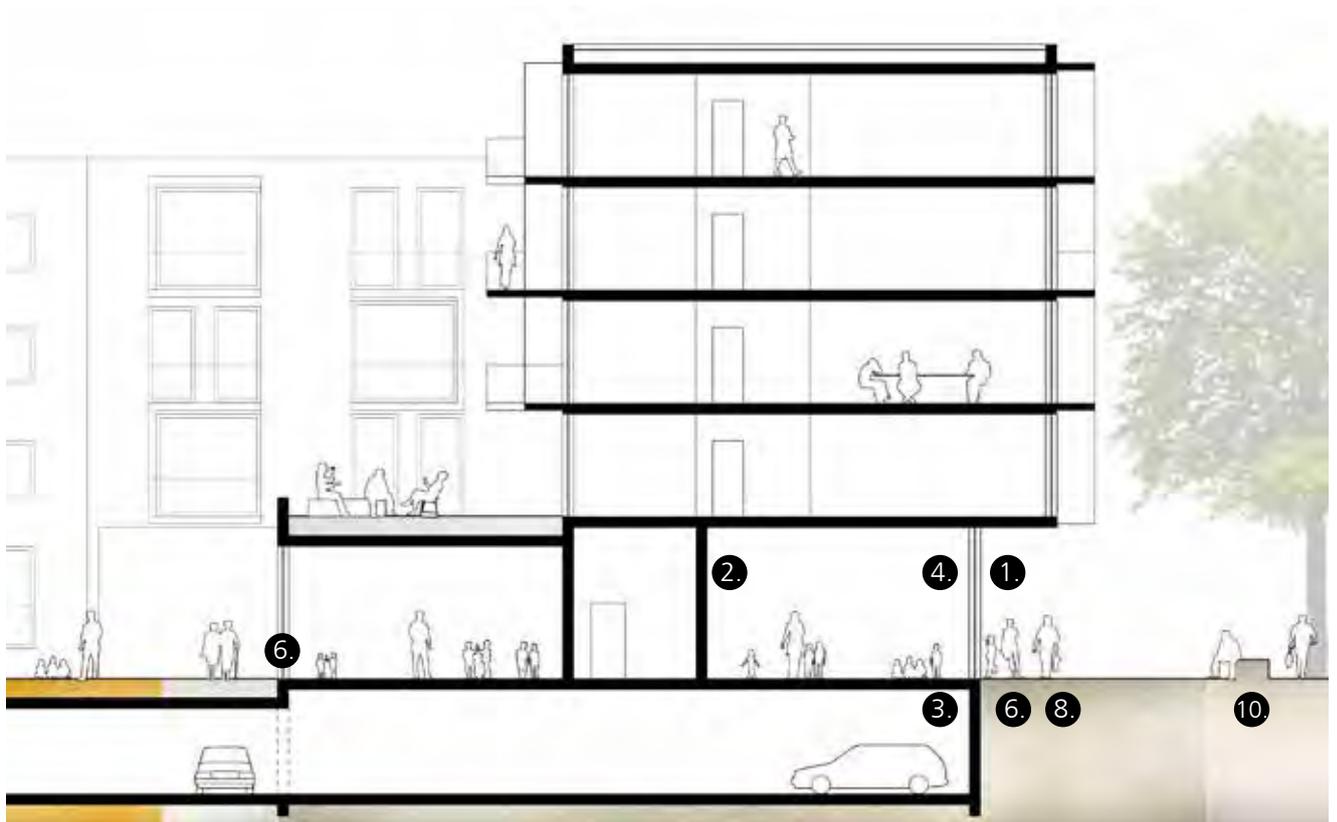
Schematischer Schnitt 1:200: Erdgeschossschnittstelle zwischen Parkterrasse (Rheinstraße) und Innenhof
